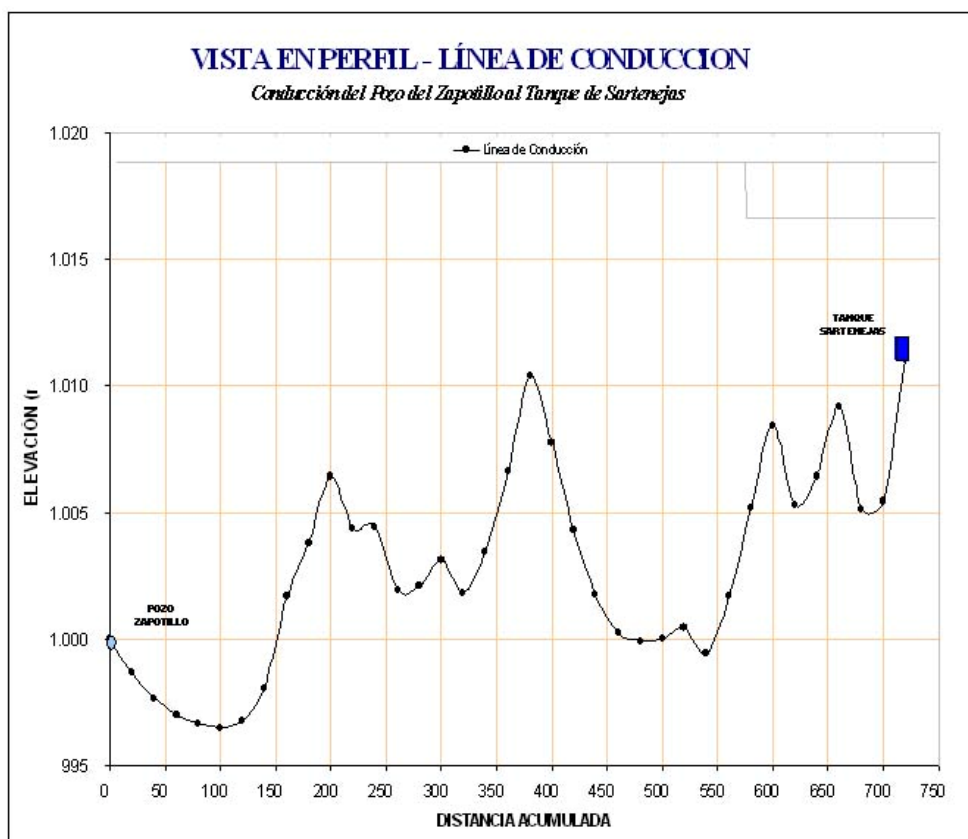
Perfil levantamiento entre el Pozo de El Zapotillo y el Tanque de Sartenejas
